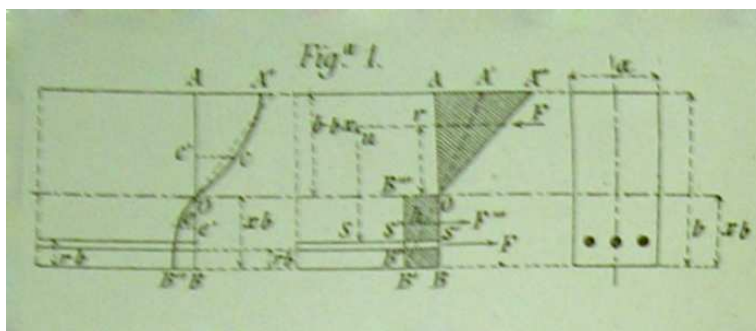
Diagrama de tensiones del hormign. (Marv, 1902)
